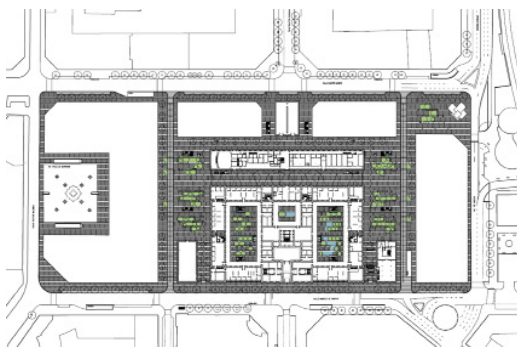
Plano de planta de cubiertas del conjunto rehabilitado.
